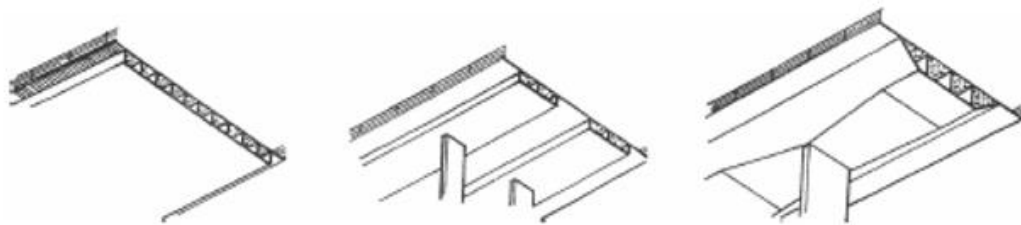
Tipos de Seção Celular. Fonte: Adaptado de Fu e Wang (2015)
